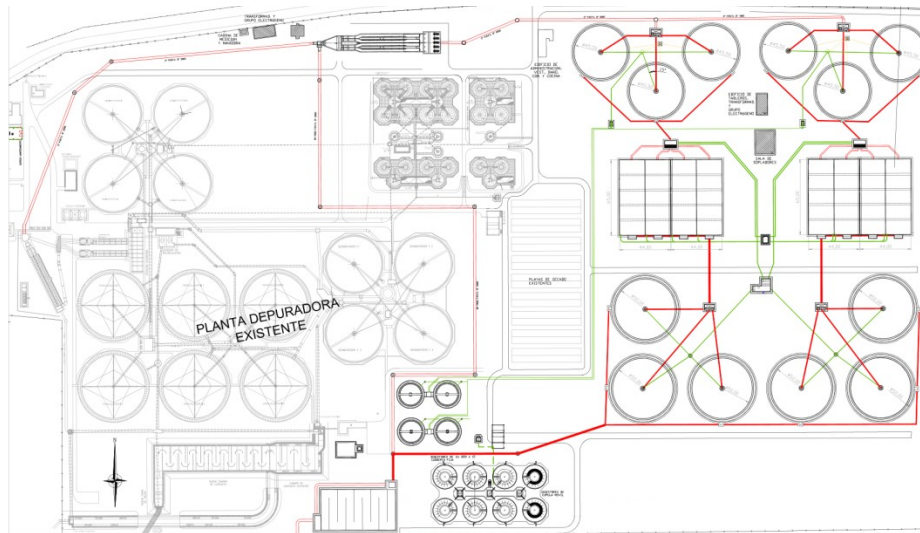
Layout planta depuradora, presenta la futura instalación.
